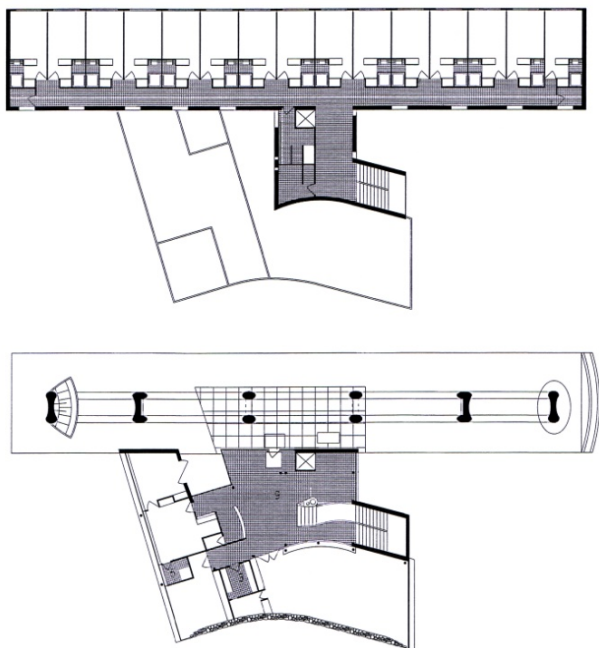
e 23- Planta piso 1 e piso térreo, Pavilhão Suíço
